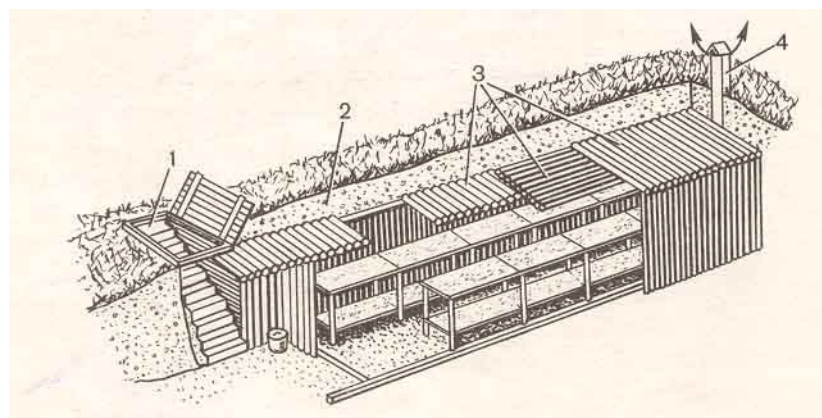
Противорадиационное укрытие из тонких бревен и жердей: 1 – вход; 2 – грунтовая засыпка; 3 – перекрытия из бревен; 4 – вытяжная труба
